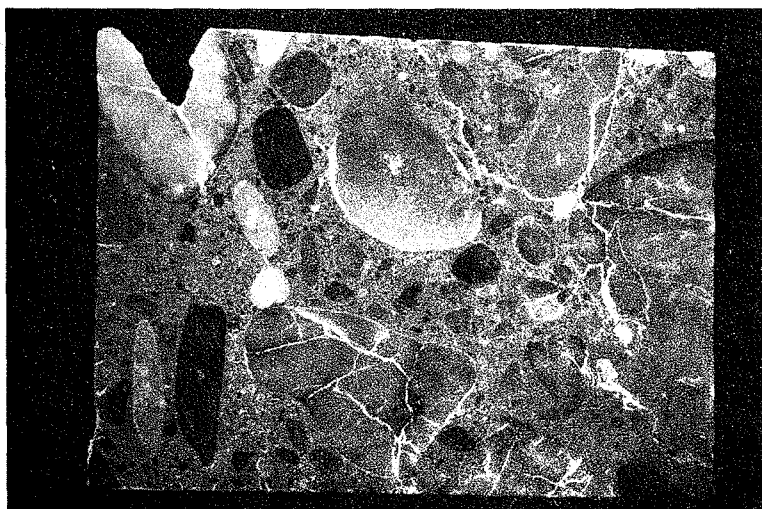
Autre béton en lumière ultraviolette-Réseau de fissurées.
